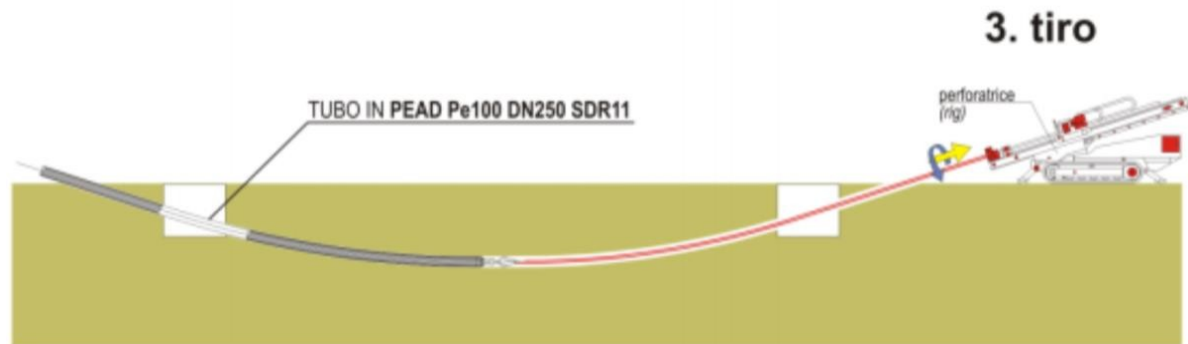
Schema esempio della fase di posa del cavidotto (Pull - Back).
